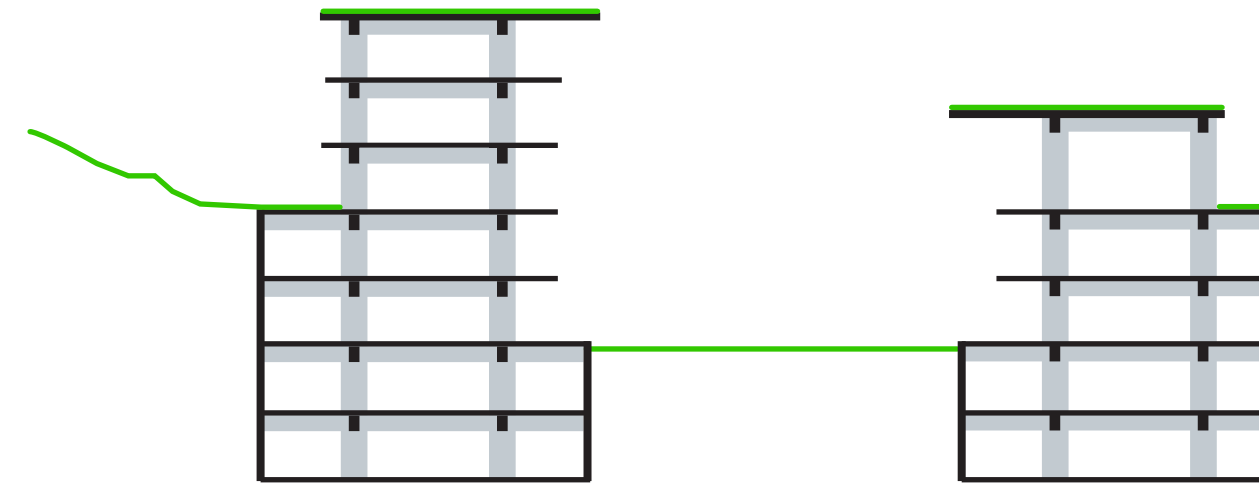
Esquema corte de la estructura. Fte.: Elaboración propia
